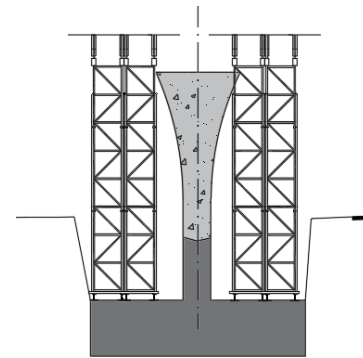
Detalle del cimbrado sobre la cimentación en el apoyo central para su construcción.
